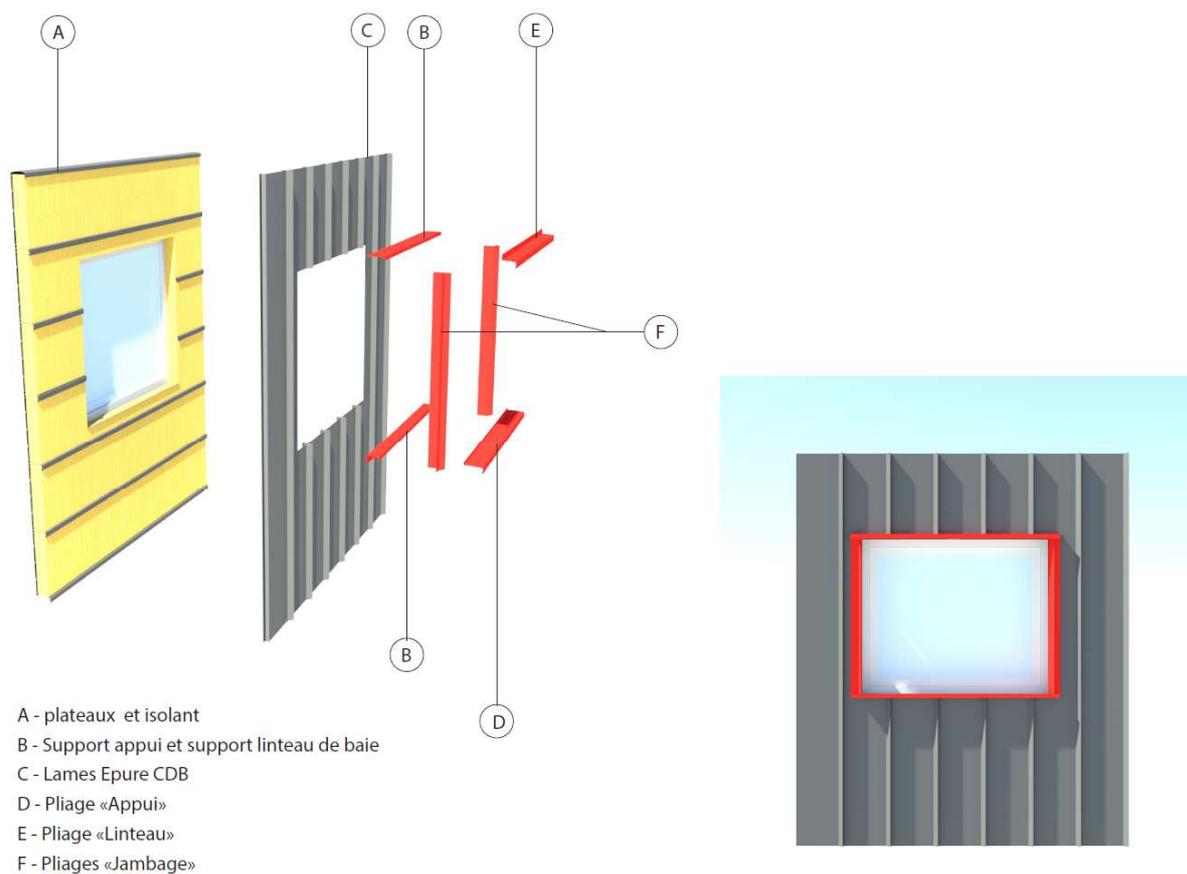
Habillage de baie en pose verticale en bardage double peau sur plateaux
